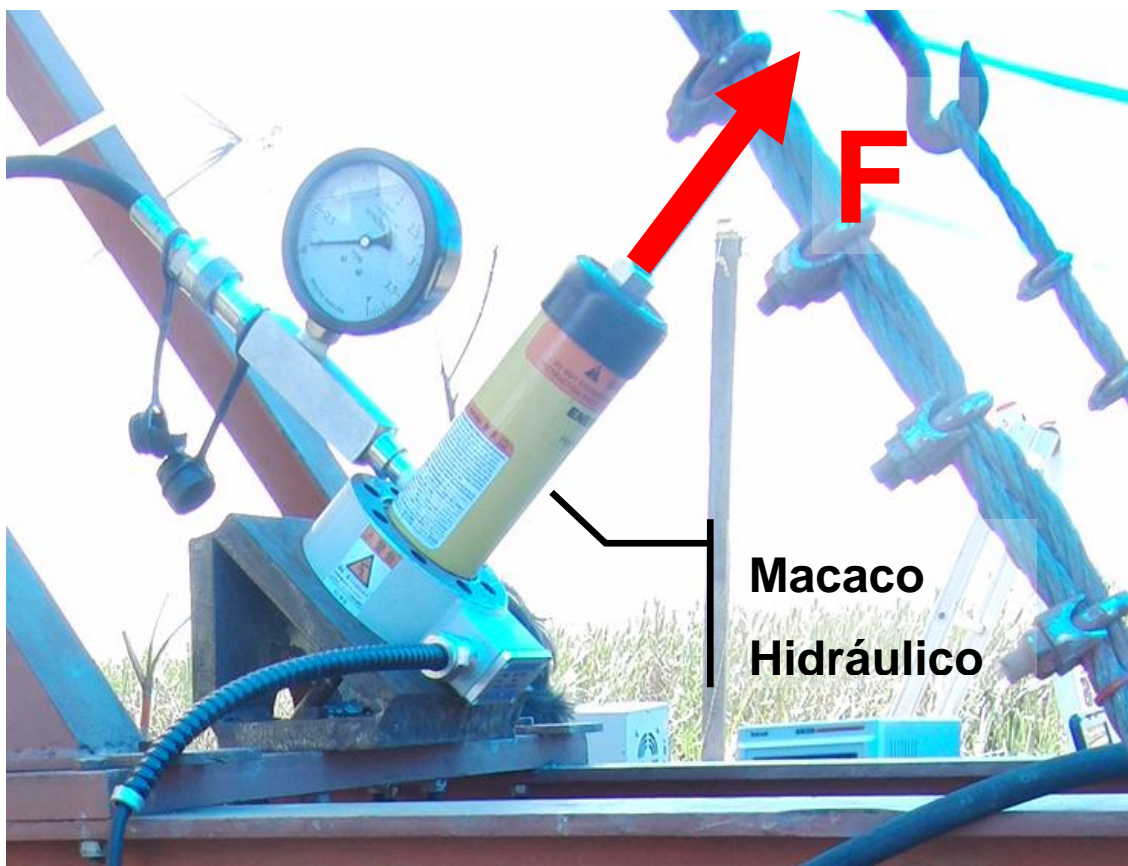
Detalhe do macaco hidráulico posicionado para a prova de carga
